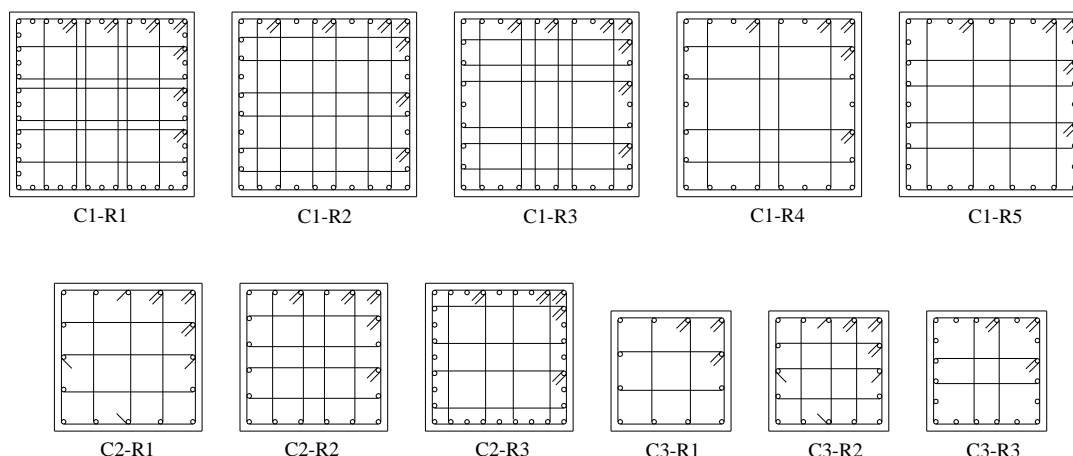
Secciones y refuerzo de las columnas del modelo DQ4CP1.7
